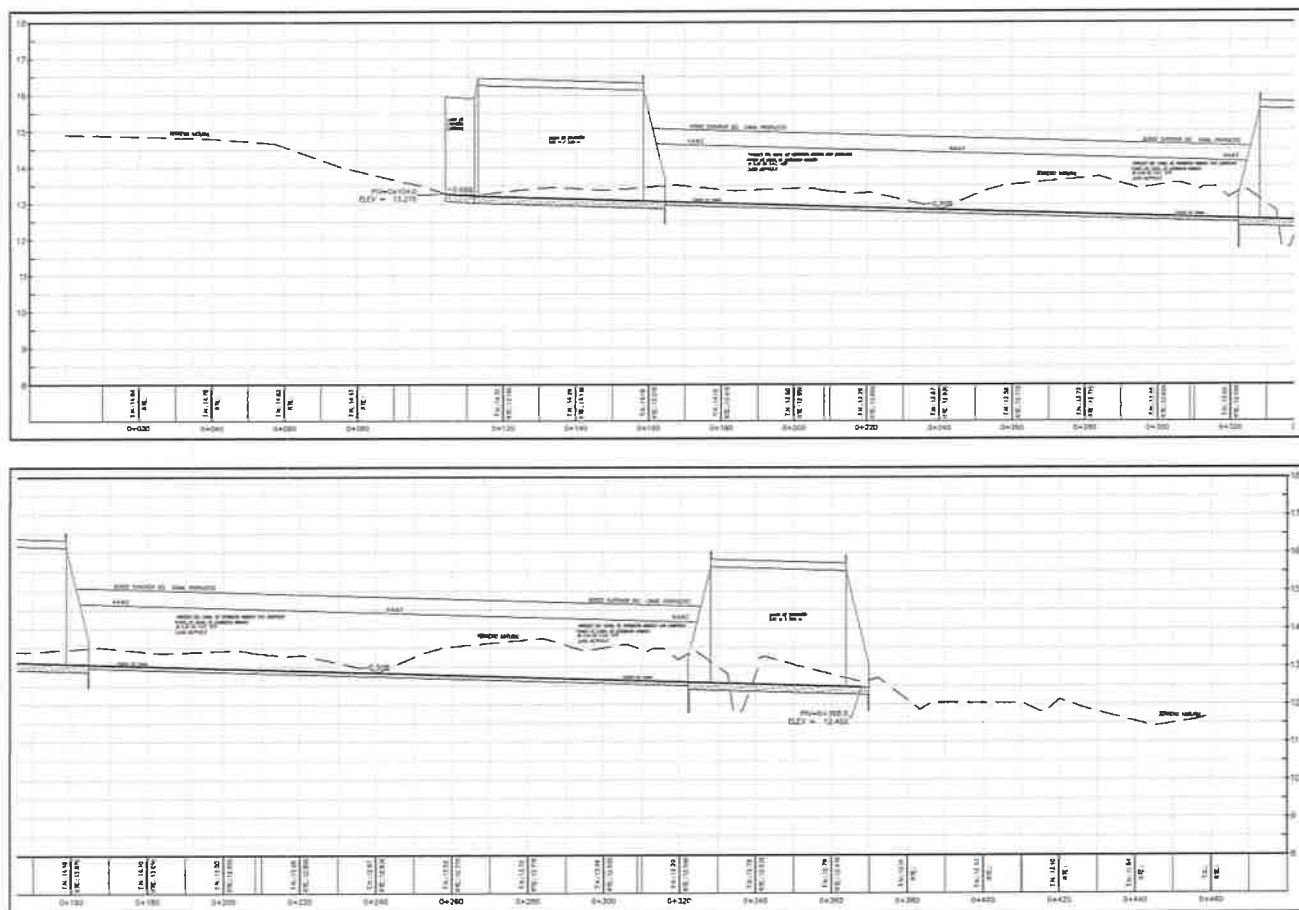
y 10: Extracto del plano para la sección longitudinal conformada en concreto, propuesta para el drenaje pluvial "Sin Nombre 1"
